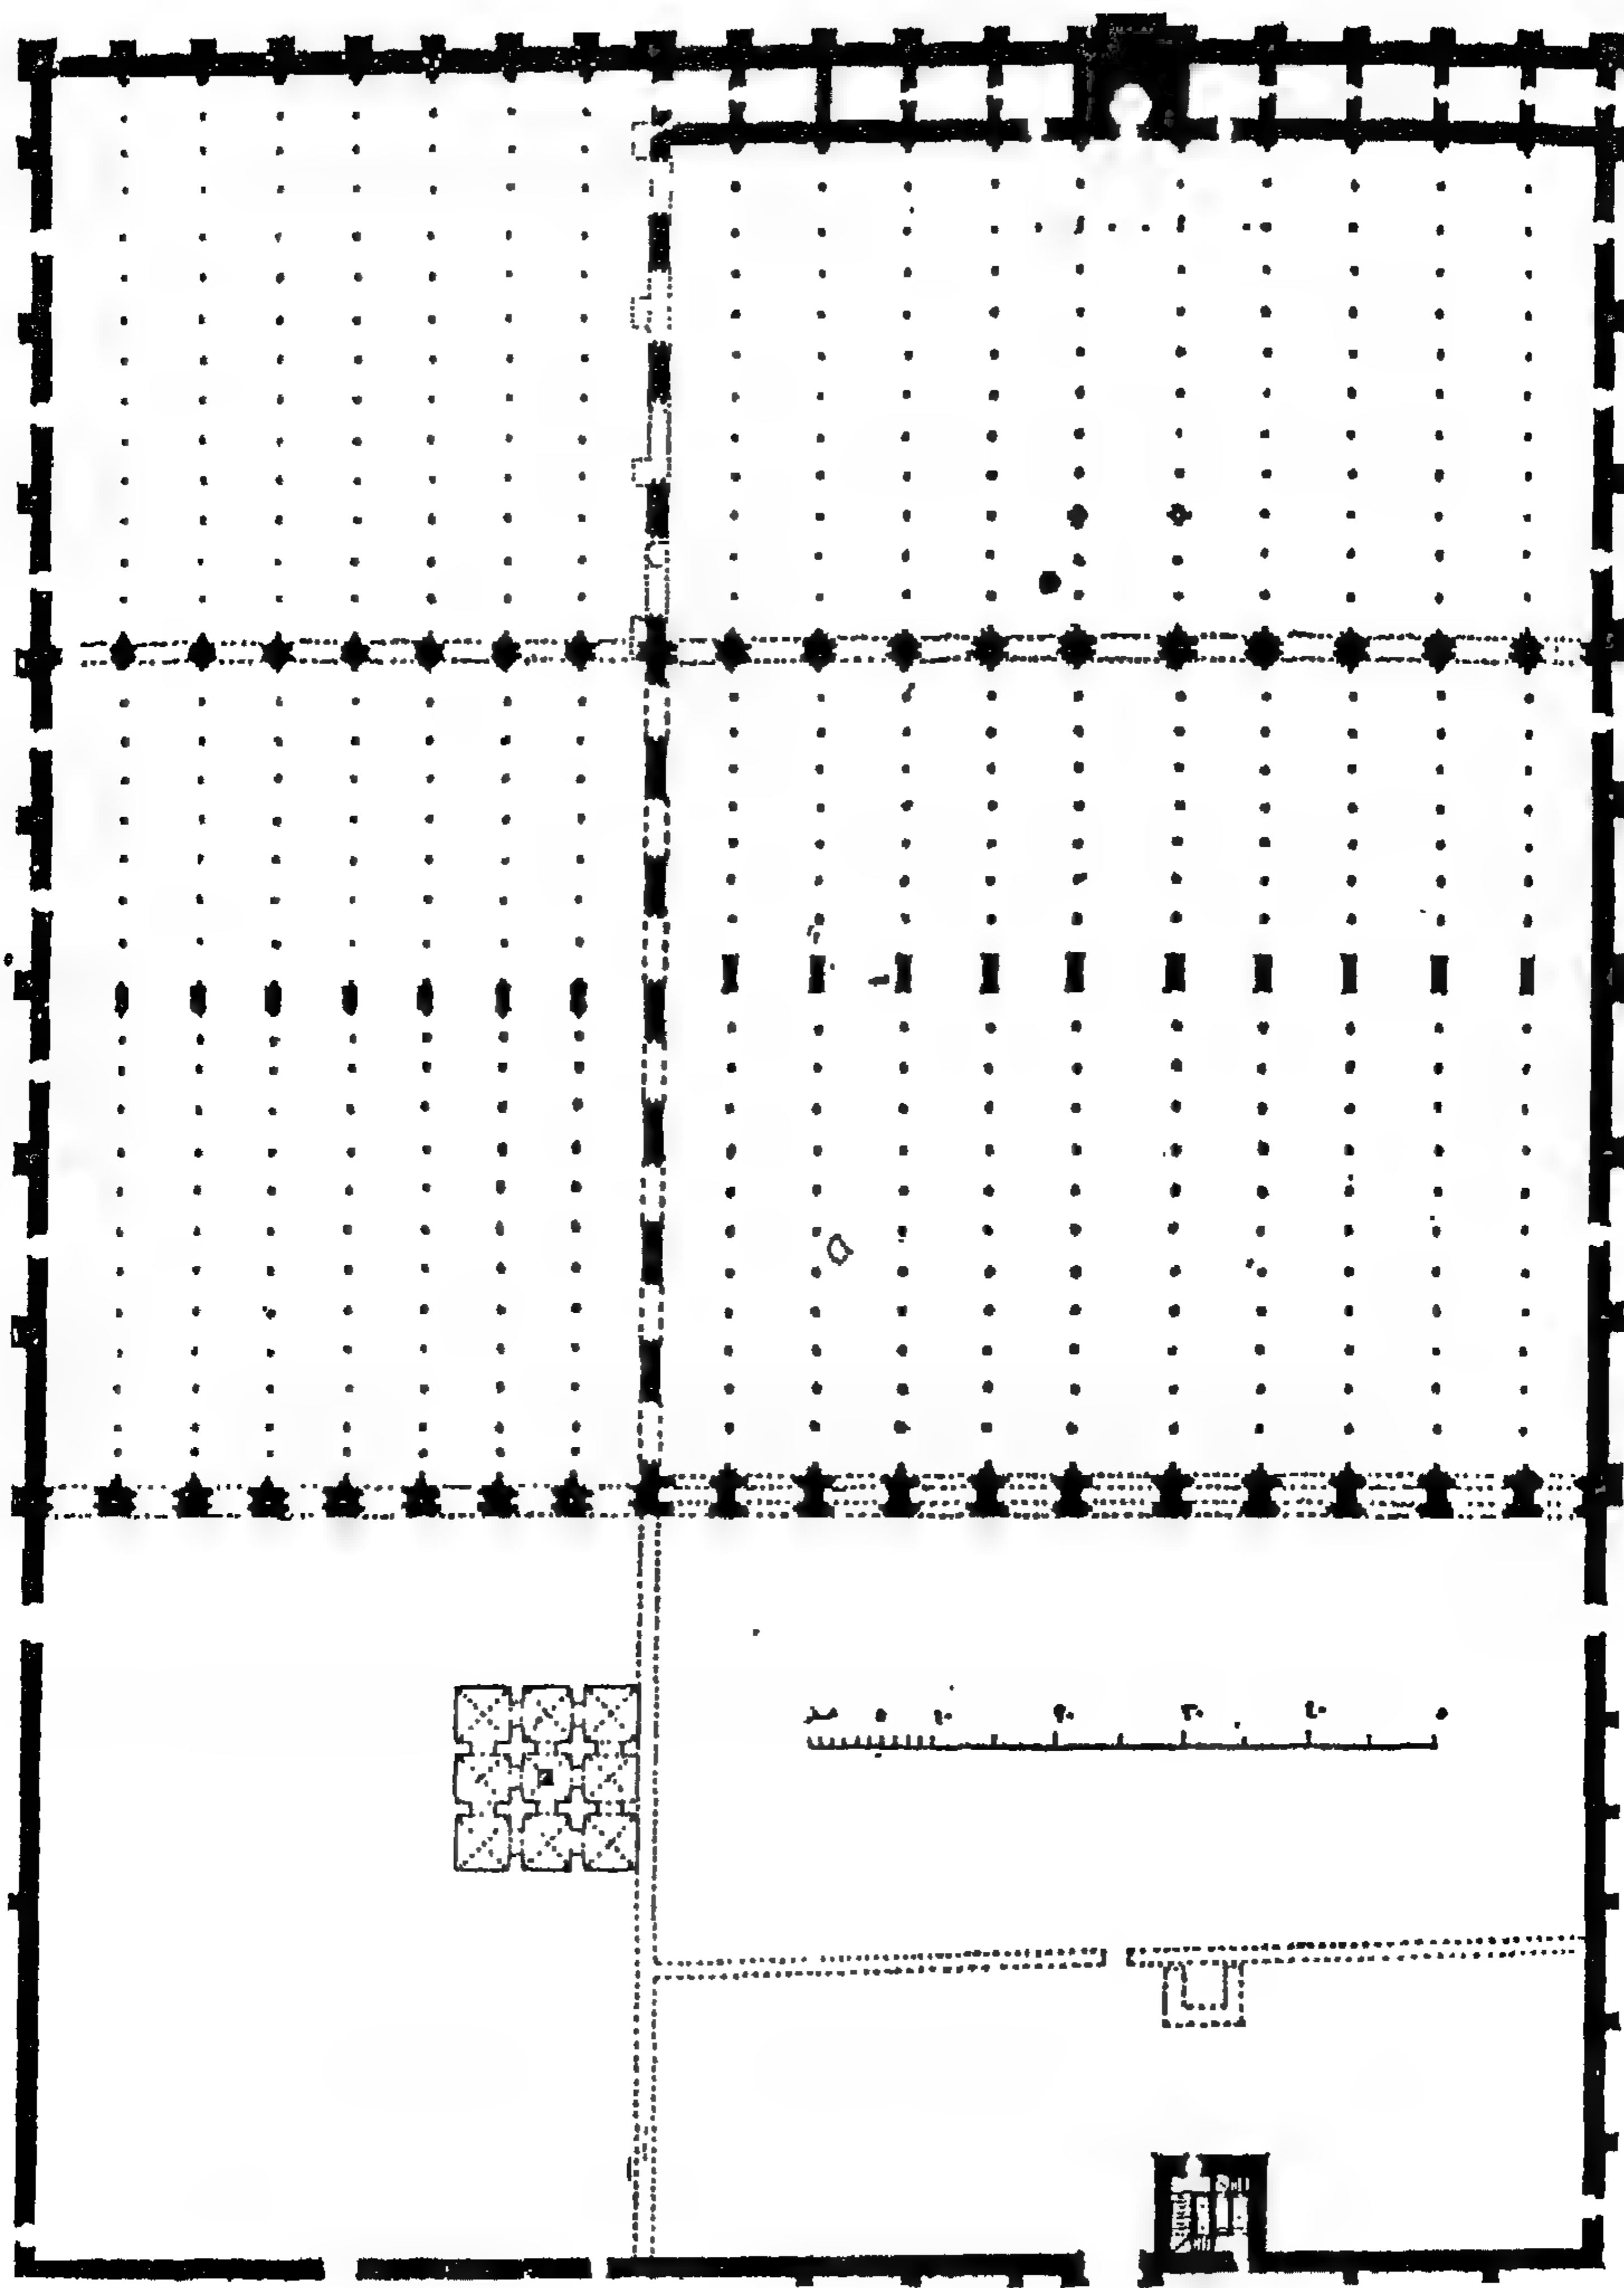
مسقط أفقي لجامع القيروان بتونس (عن : Lezine) .
